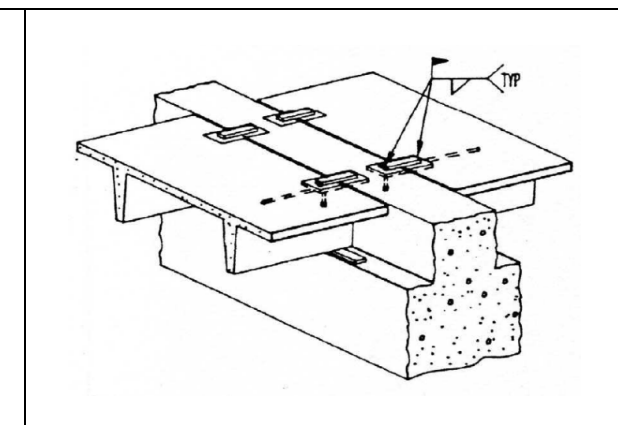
Ligação de lajes duplo “T” em vigas “T” invertido, através de chapas aparafusadas, assentes em neoprene, em paralelo com a laje (PCI).
